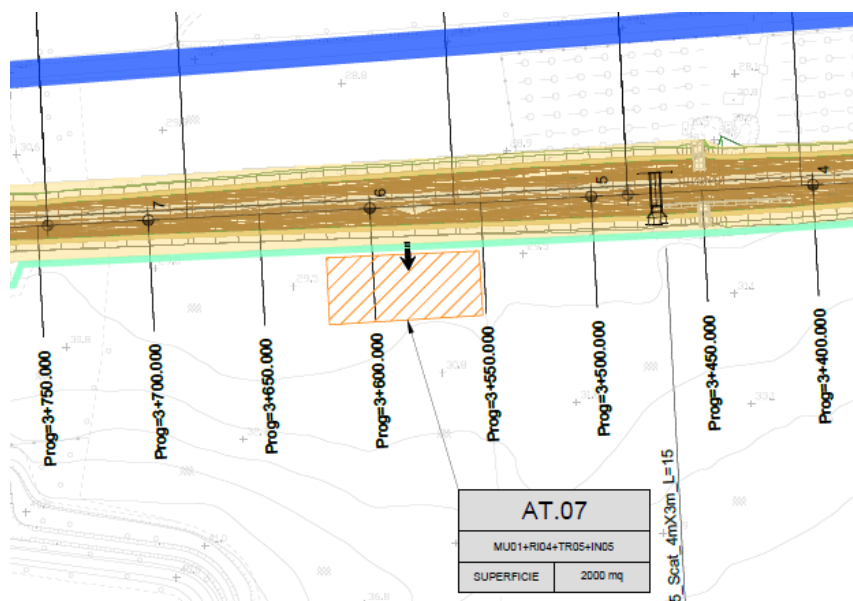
Vista in pianta dell'area di cantiere AT.07
